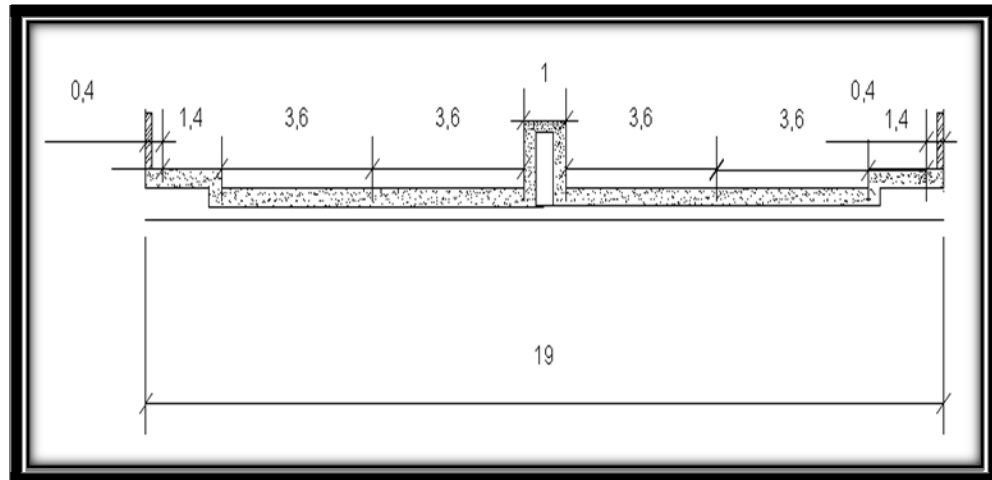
Sección Transversal para Puentes, Fuente: Minfra
